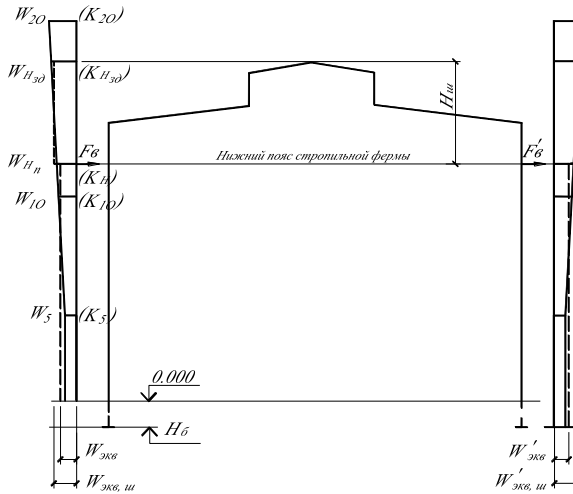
Схема для определения ветровой нагрузки на поперечную раму промышленного здания
